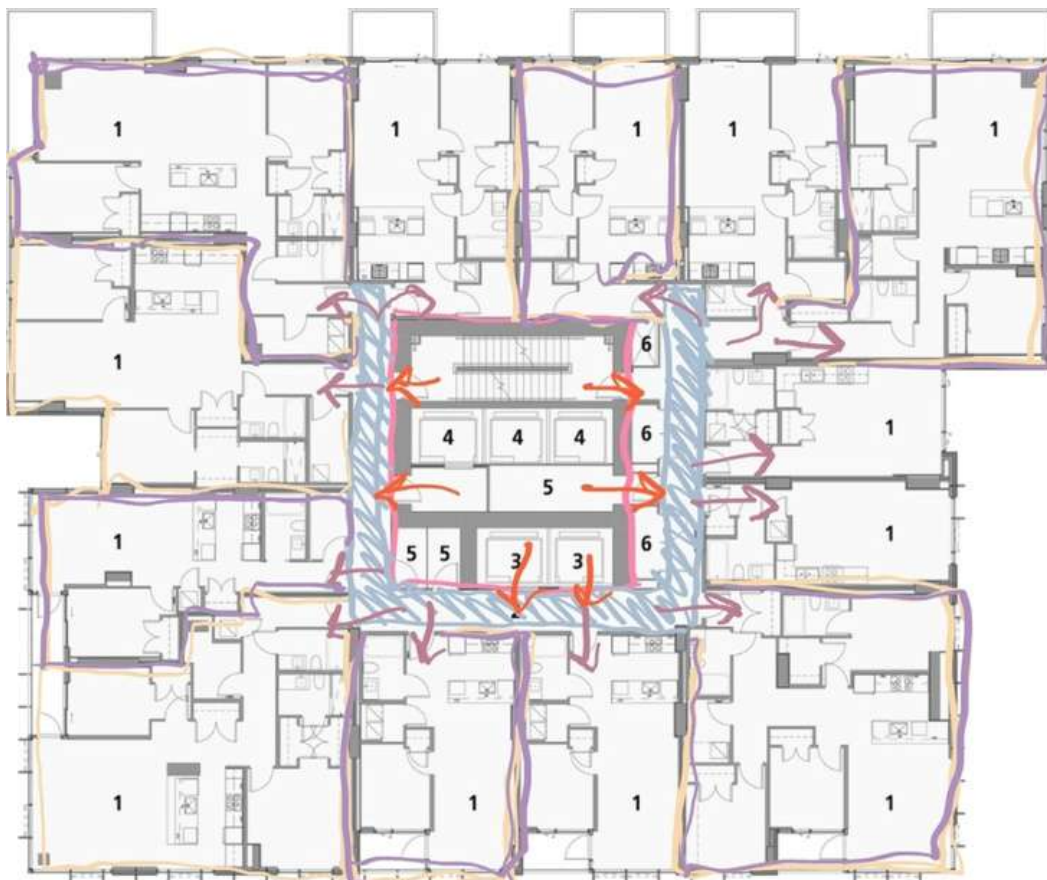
Planta arquitectónica intervenida con análisis. Fuente: Autoría propia
